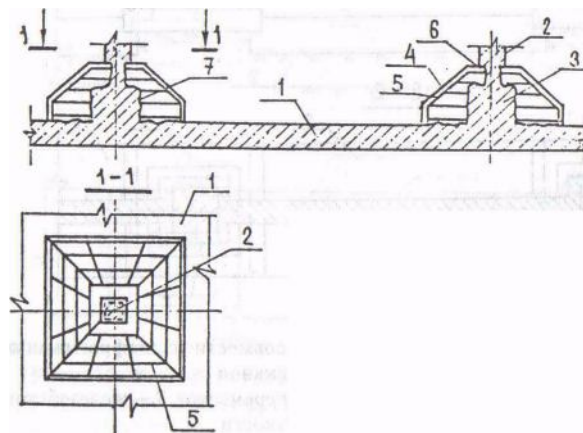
Збільшення опорної площі залізобетонного стовпчастого фундаменту
